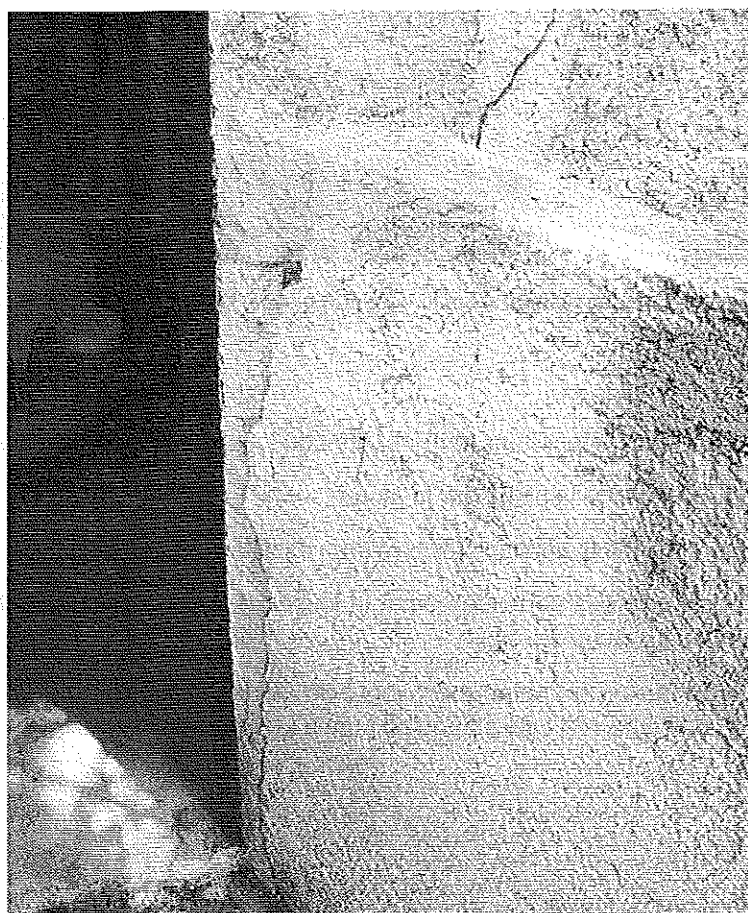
Fissure verticale entre mur local machinerie et mur en retour (accès au local). © J. Putatti
